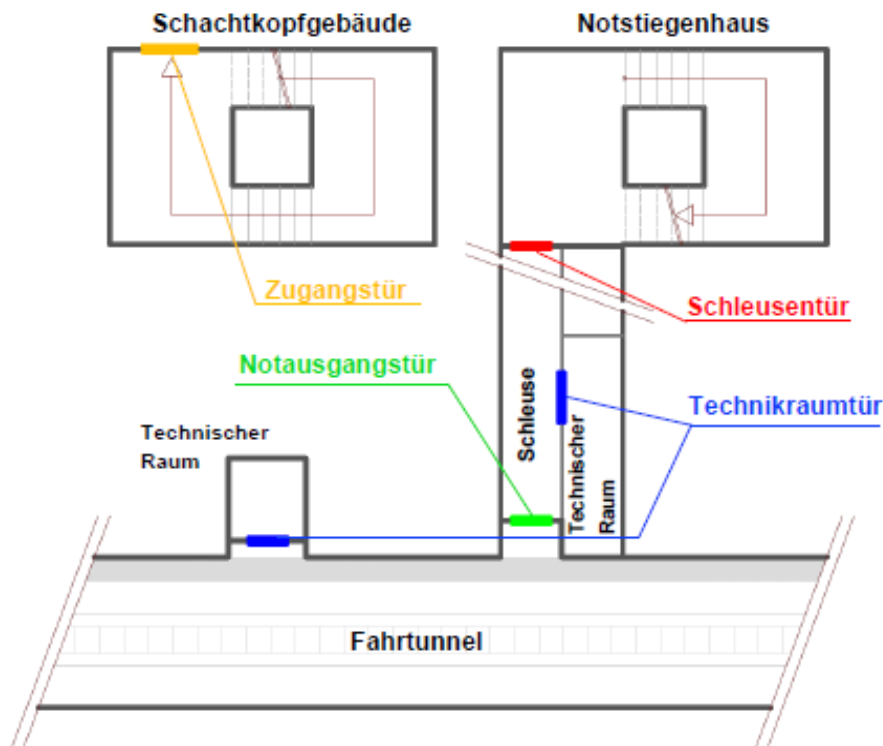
Tunnelbauwerk bei Anordnung eines Notstiegenhauses mit Schachtkopfgebäude an der Oberfläche
